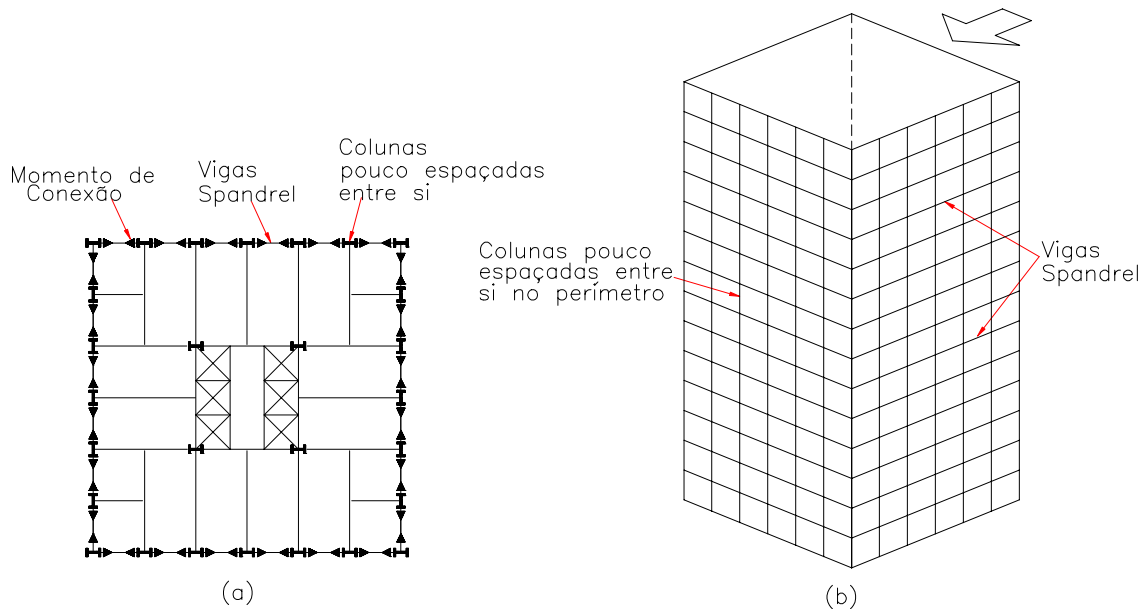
Edifício tubular aporticado: (a) planta esquemática;
